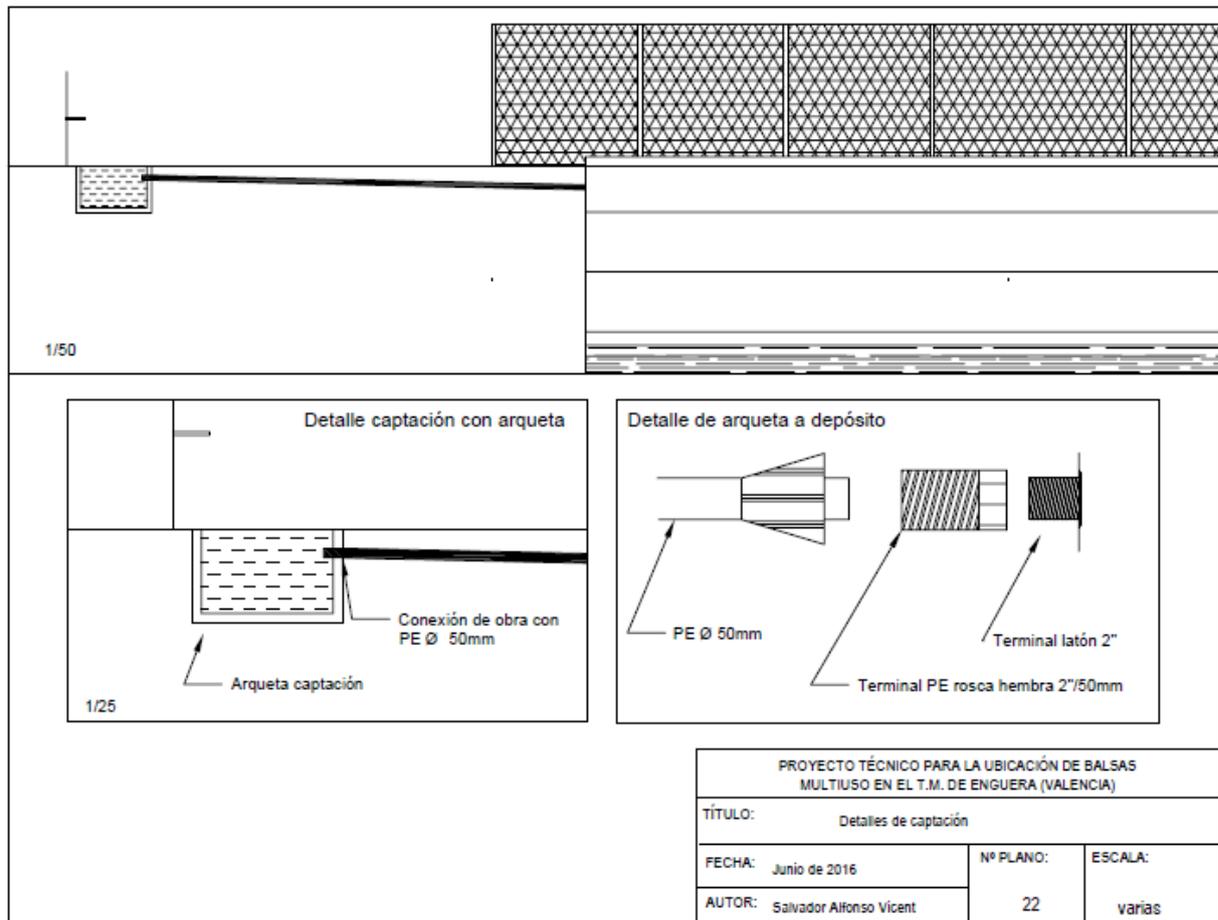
Plano de detalles de captación. Fuente: elaboración propia con Autocad
